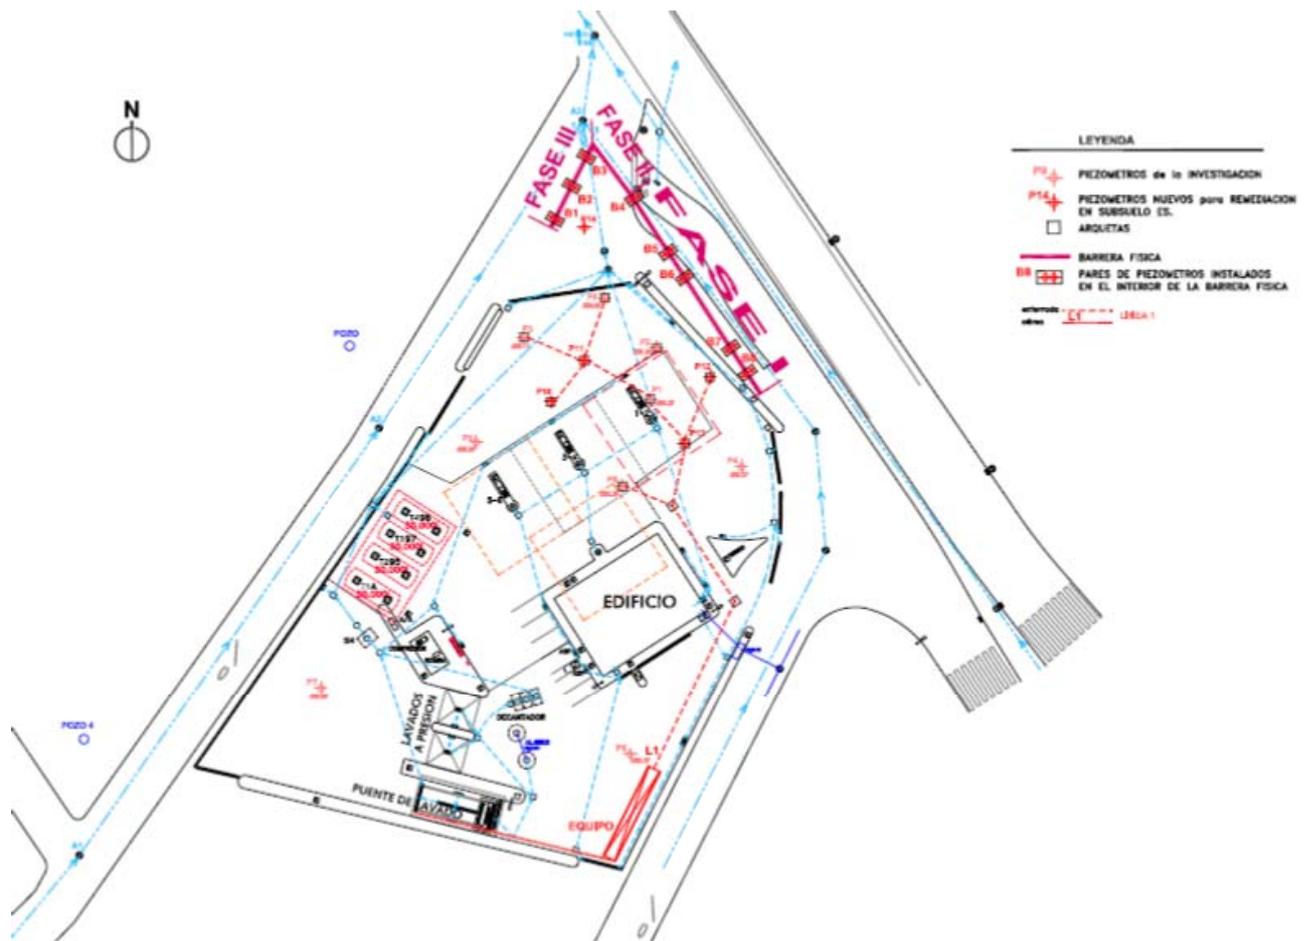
Detalle de la red de dispositivos de control y seguimiento instalados en el emplazamiento
